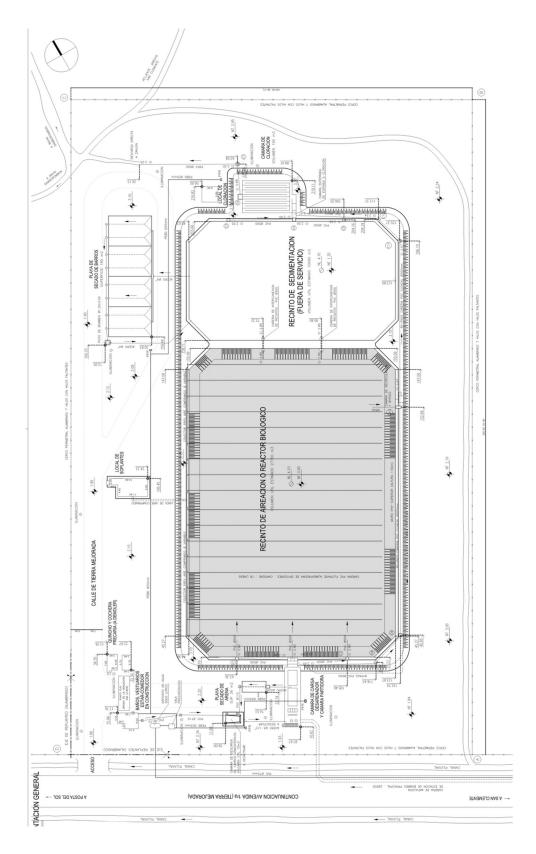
Vista en planta del tratamiento de efluentes en San Clemente del Tuyú. (Implantación- Cortesía COS)
